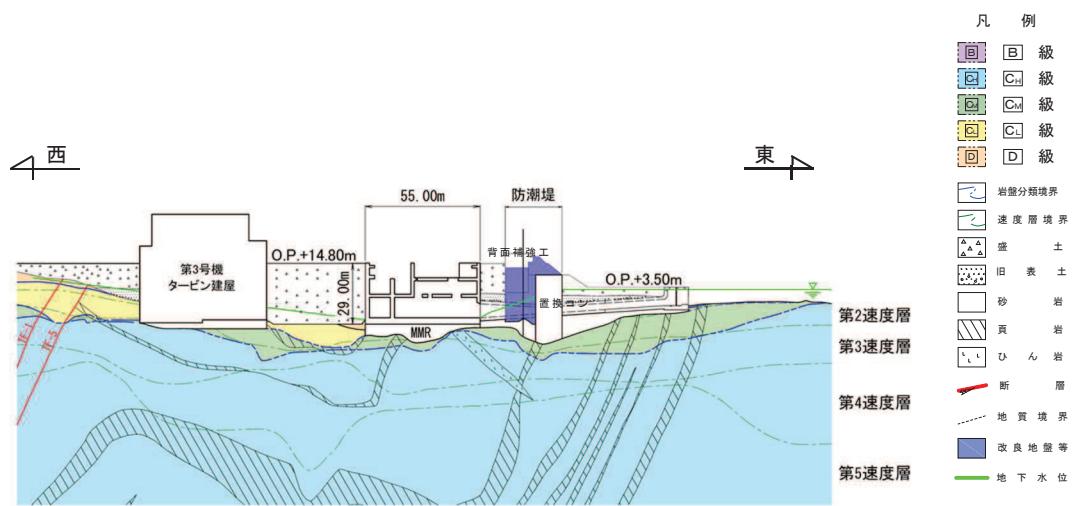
(3) 第3号機海水ポンプ室 地震時荷重算出断面図（東西方向）
